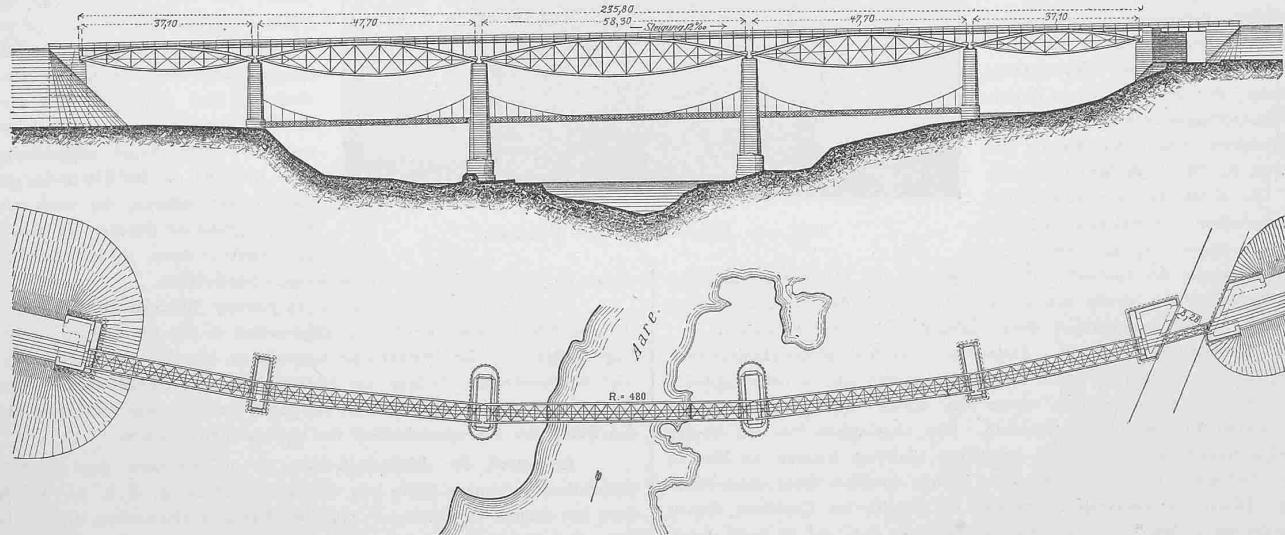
Die Eisenbahnbrücke bei Brugg, erbaut 1873—1875. — Ansicht und Grundriss. — Maßstab 1:1500.
